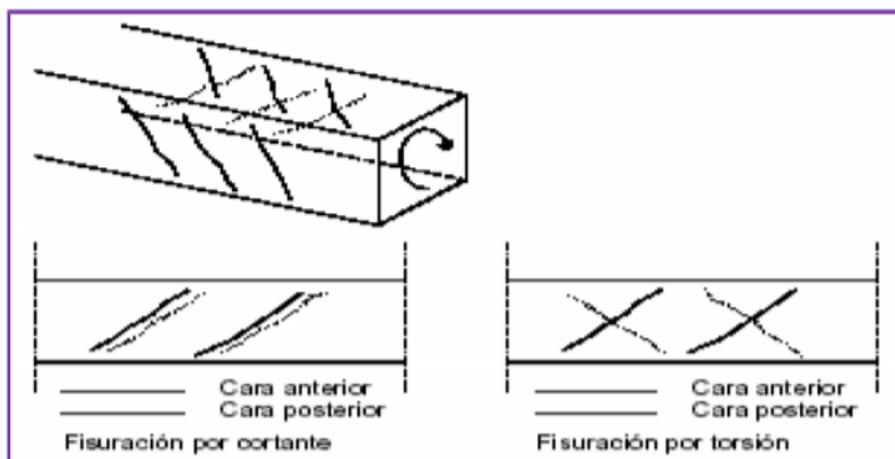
FISURACIÓN POR TORSIÓN
